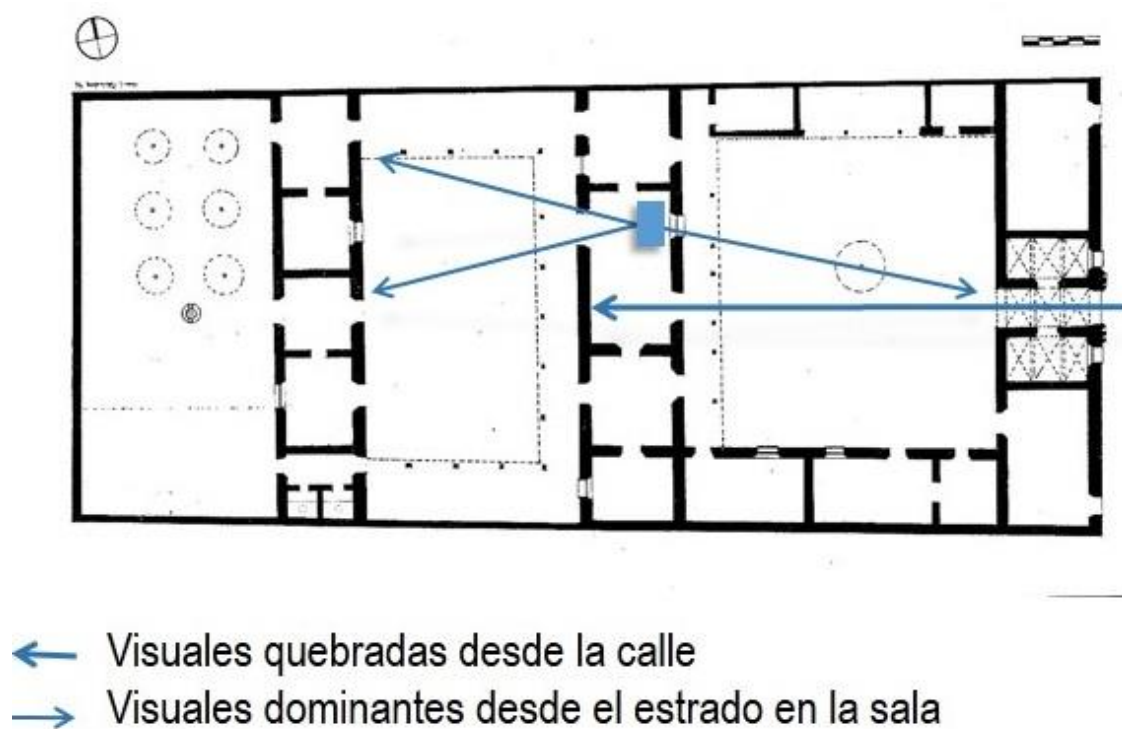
Planta de la Casa en 1838. Visuales. Elaboración propia
